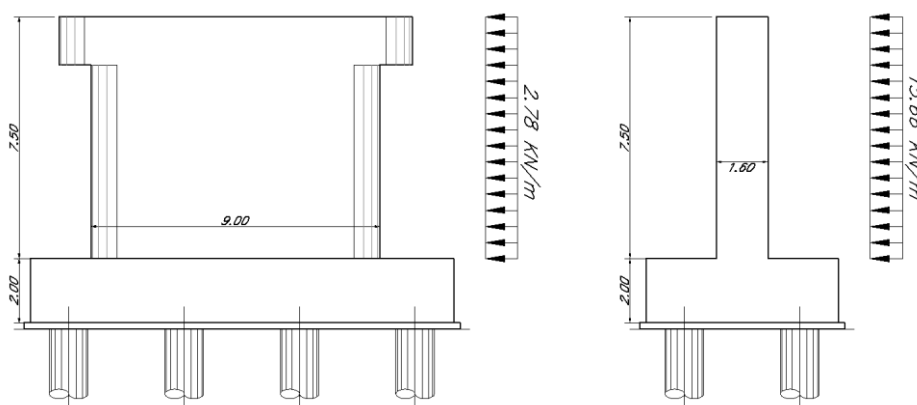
Carico distribuito longitudinale e trasversale del vento sulla pila
